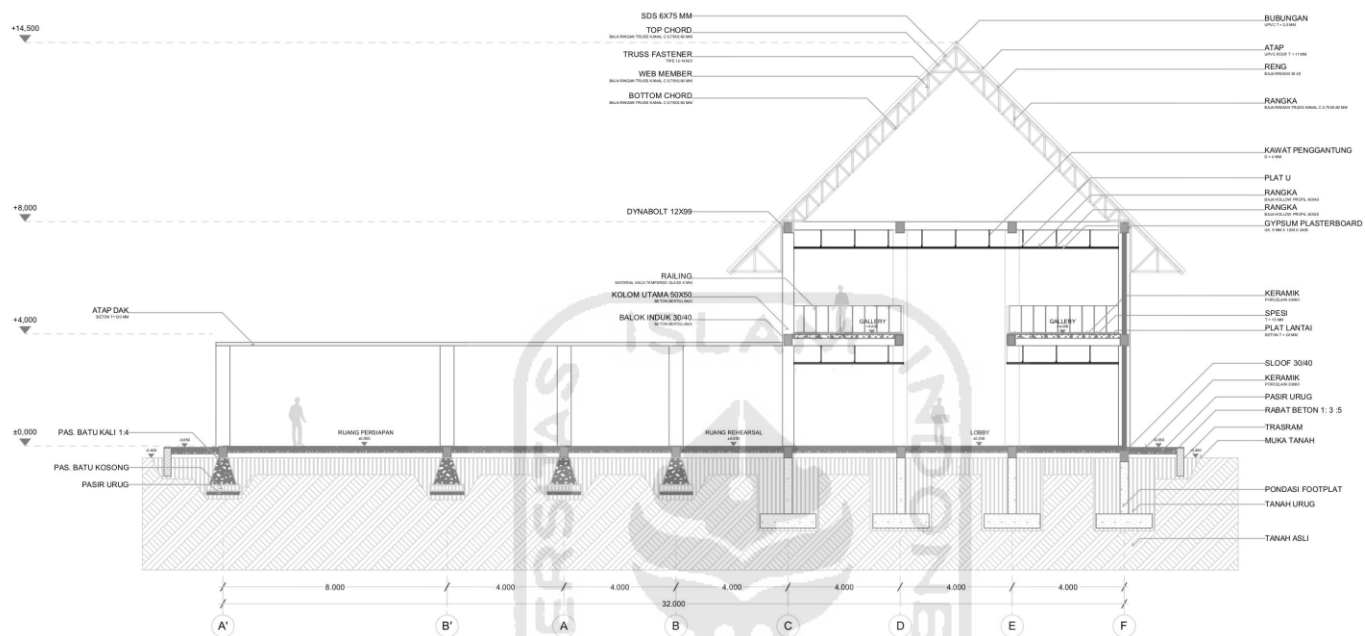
Potongan s-01 bangunan workshop (Sumber: Penulis, 2021)
